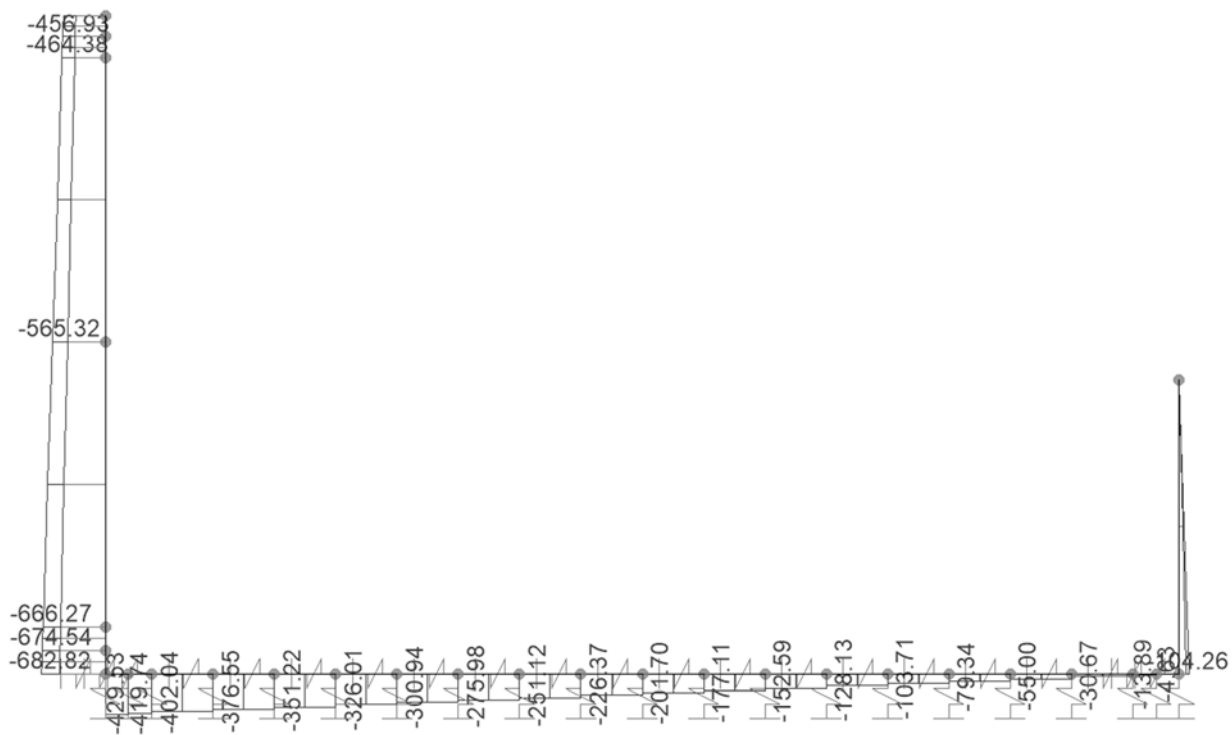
SLU – Piedritto e platea di fondazione – Sforzi assiali Ned
